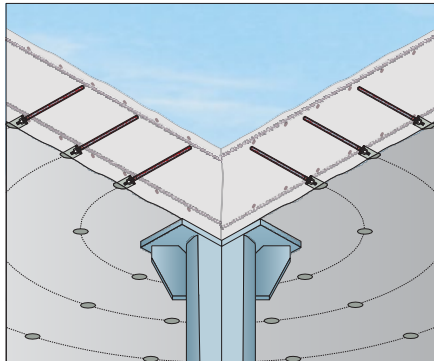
Nachträglich eingebaute Durchstanzbewehrung
